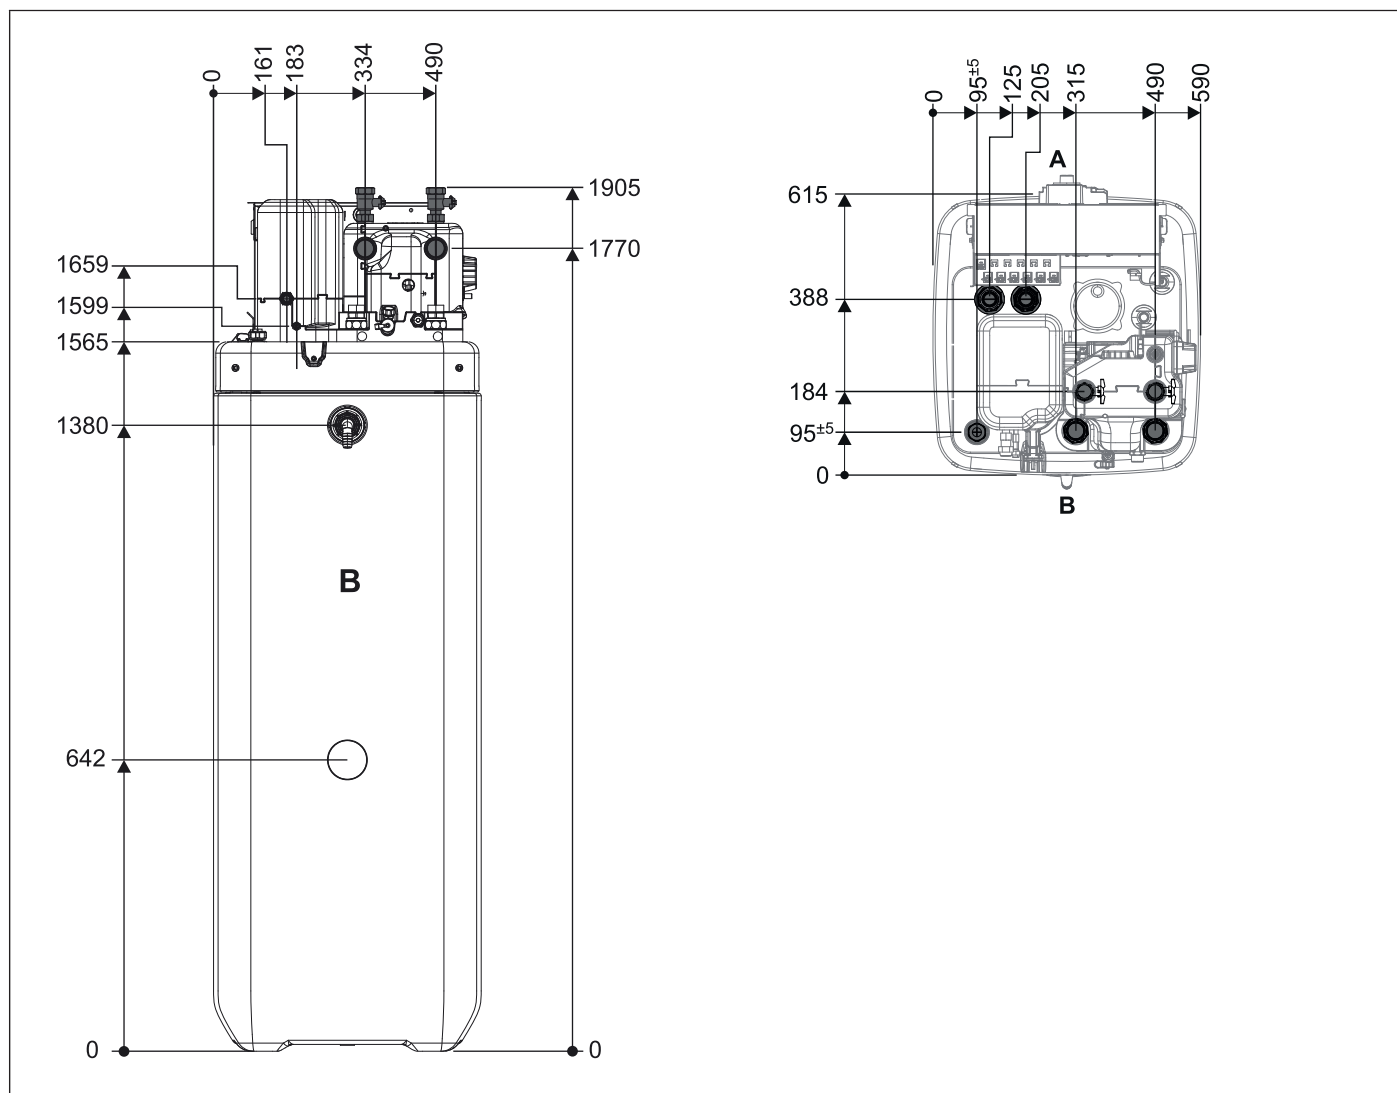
Abmessungen Innengerät HPSU compact Ultra 300l
